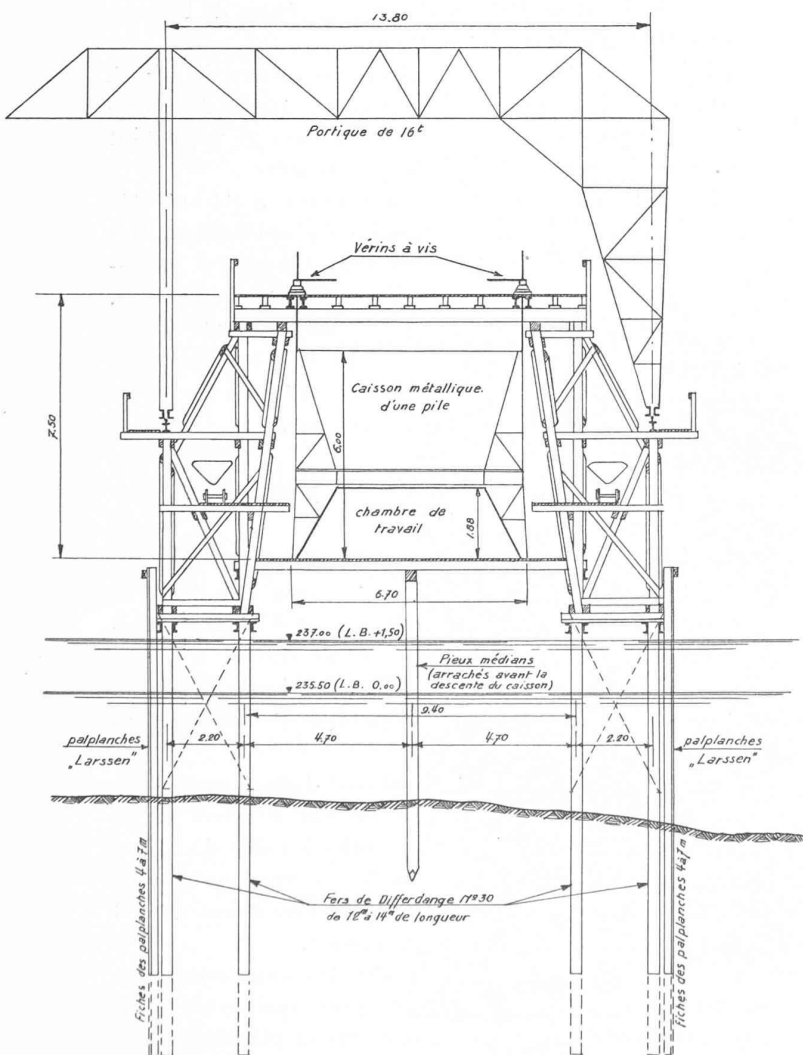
Echafaudage des caissons des piles. — Coupe transversale. Echelle 1 : 200.
